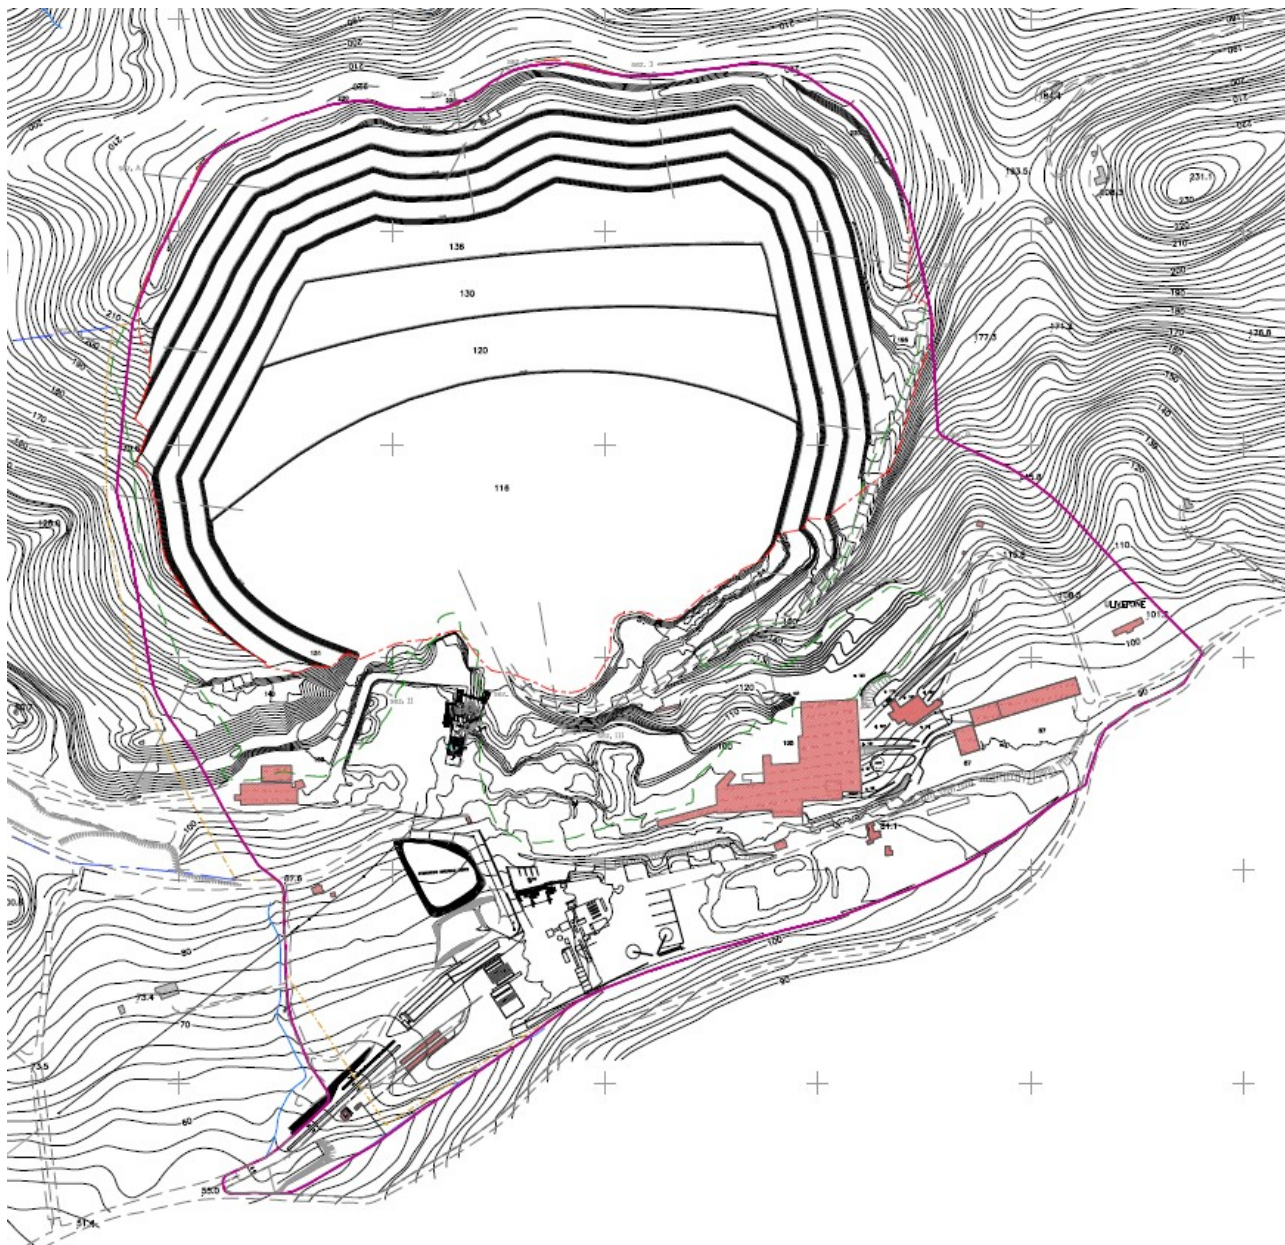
Stato finale escavazione Monte Valerio - Variante all'autorizzazione vigente, per la quale ha avuto esito positivo il PAUR con DGRT 882/2021 ed è stata rilasciata autorizzazione comunale del progetto a breve termine con Atto unico suap/2022/28
